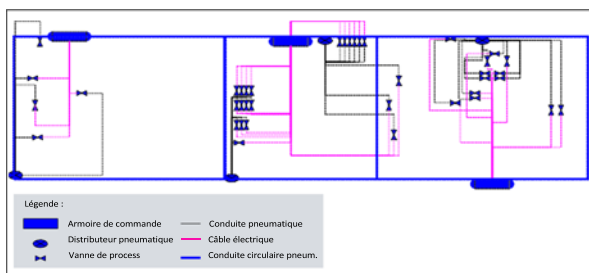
examen détaillé du rez-de-chaussée – Distributeur individuel.
